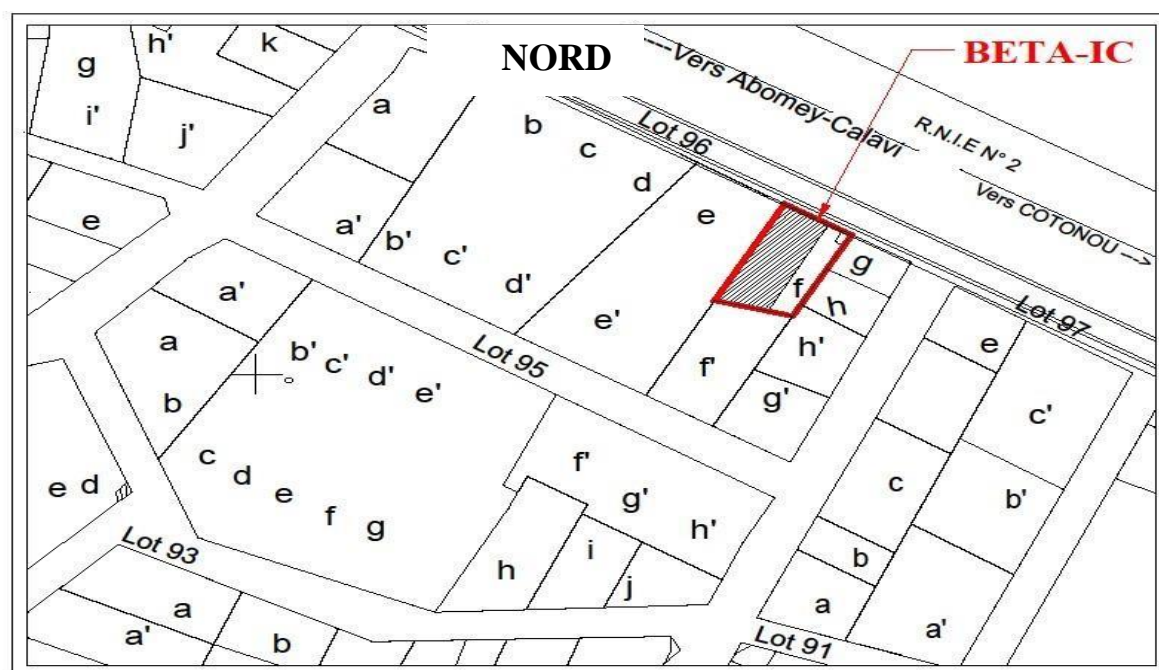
Plan de situation du cabinet BETA-IC Echelle 1 /2000
